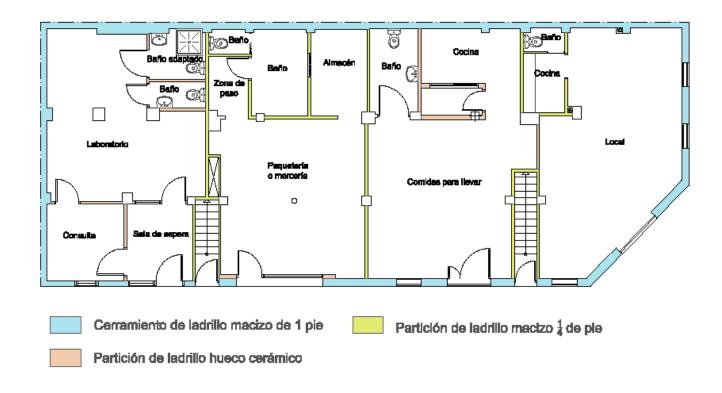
Esquema de tipologías de tabiquería en planta baja. Elaboración propia
